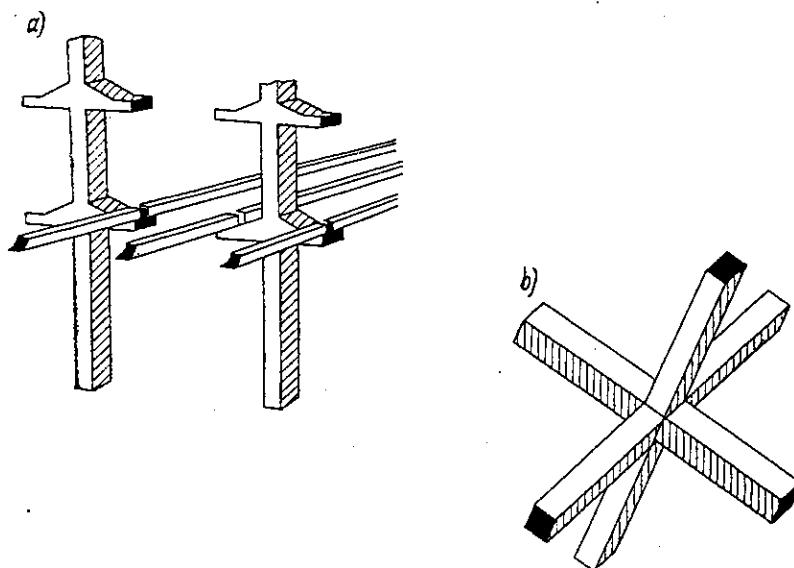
Hệ cấu kiện módun cho nhà khung
